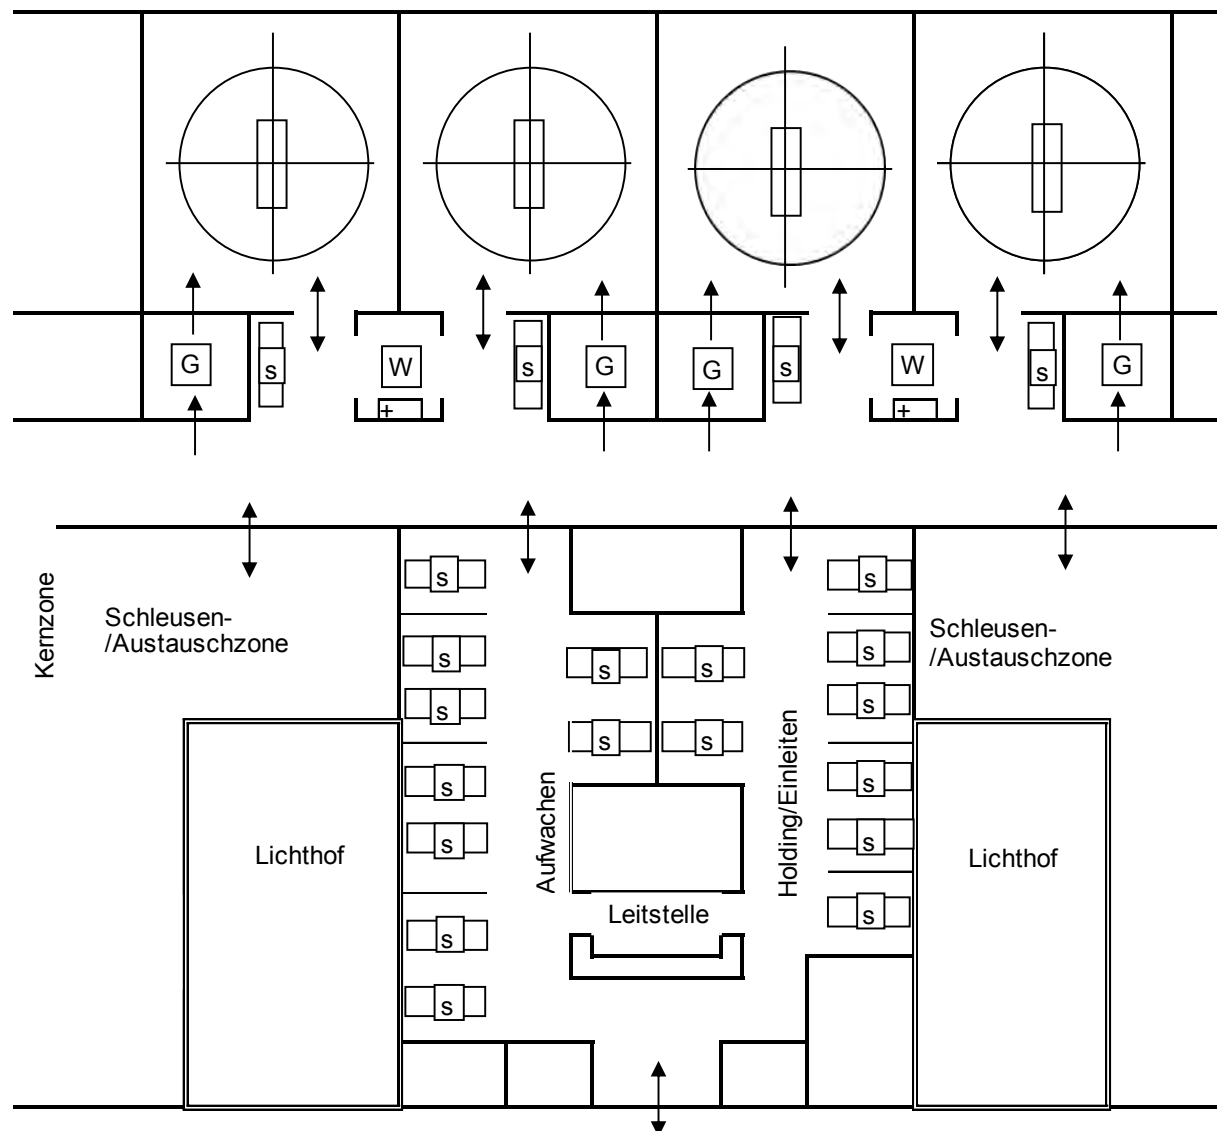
Systemgrundriss Pilotprojekt OP Greifswald (S – Stretcher)
